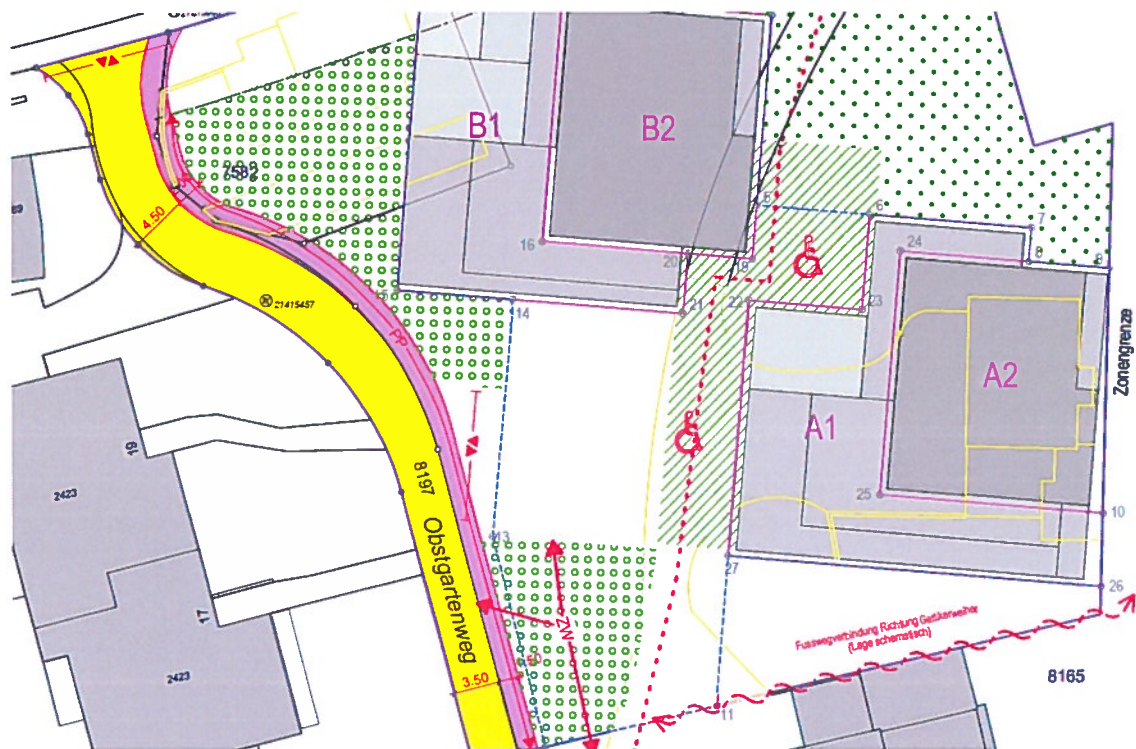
Ausschnitt Gestaltungsplan mit möglichem Ausbau des Obstgartenweg
